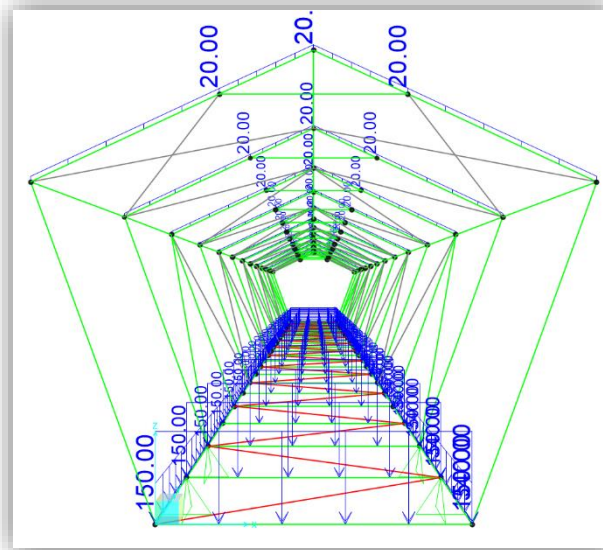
Vista en sección transversal de la estructura con carga muerta permanente (DEAD).
